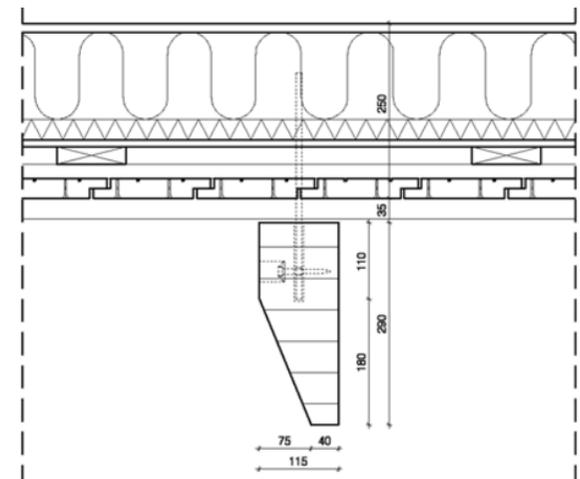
(Oben) Fassadendetailplan mit den vertikalen hölzernen schattierungselementen (Lamellen)
